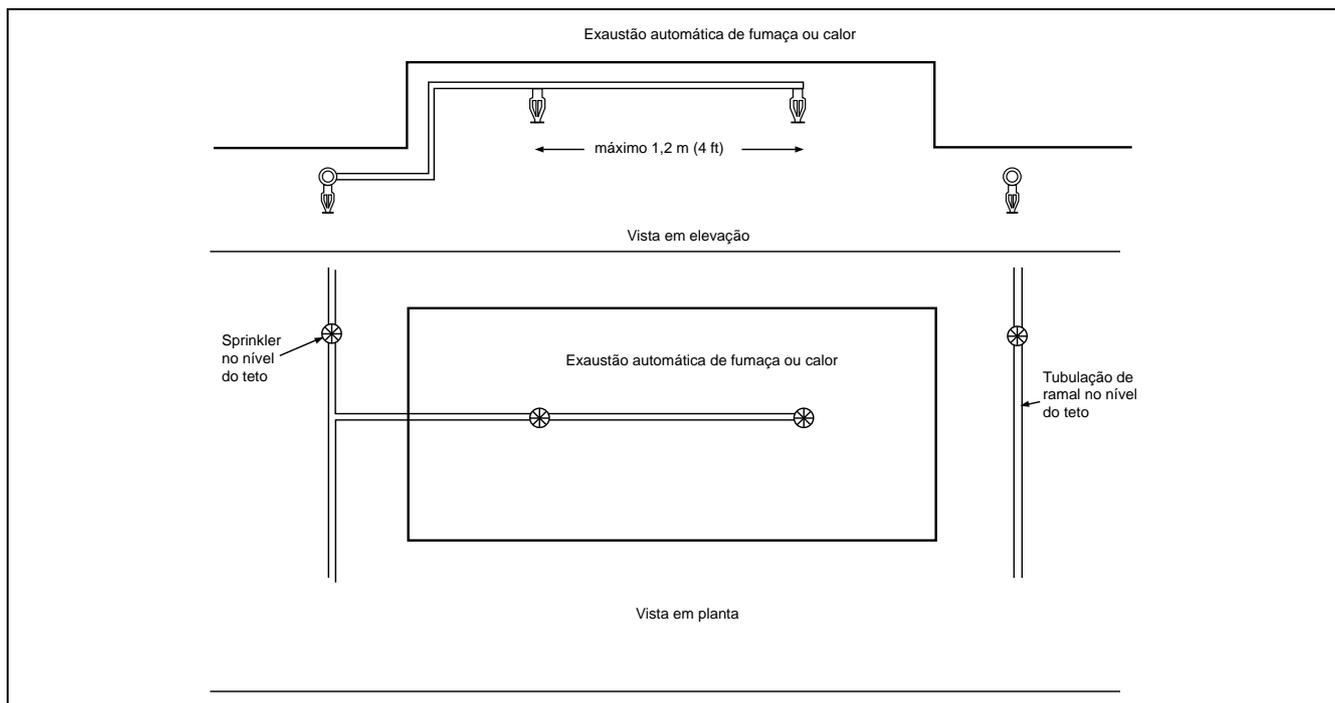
Sprinklers de resposta rápida instalados sob exaustores automáticos de fumaça e calor
